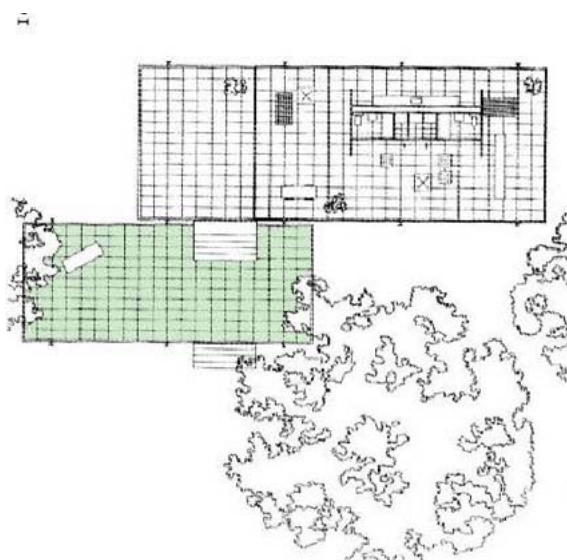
Casa Farnsworth - planta baixa - 1946
